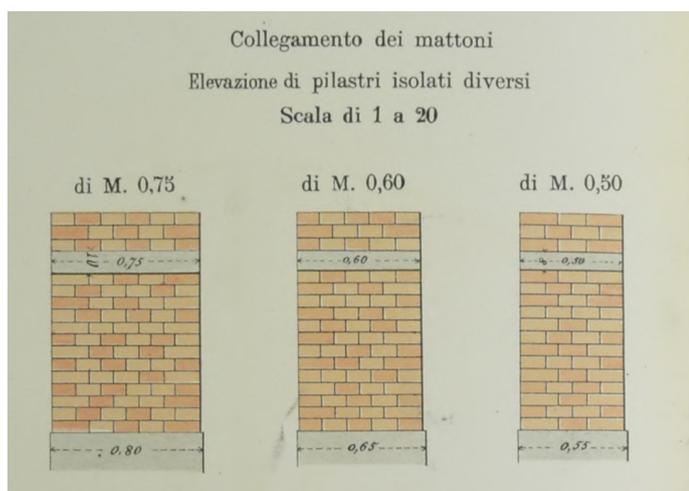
(sinistra): Dettaglio di muratura e collegamento dei mattoni. Fonte: Musso, G. e Copperi, G. (1912). Particolari di costruzioni murali e finimenti di fabbricati, Torino, G. B. Paravia, tav. VI.
